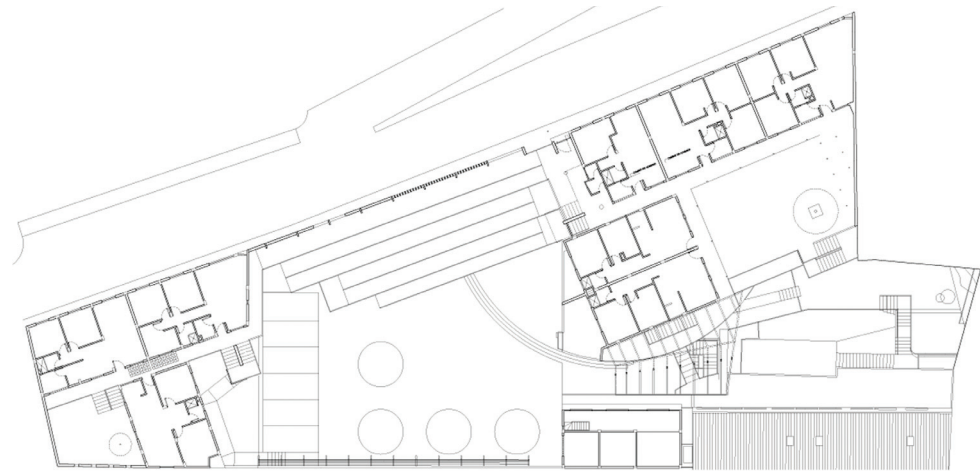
Planta N=+ 3.18, 4.37, 4.55
